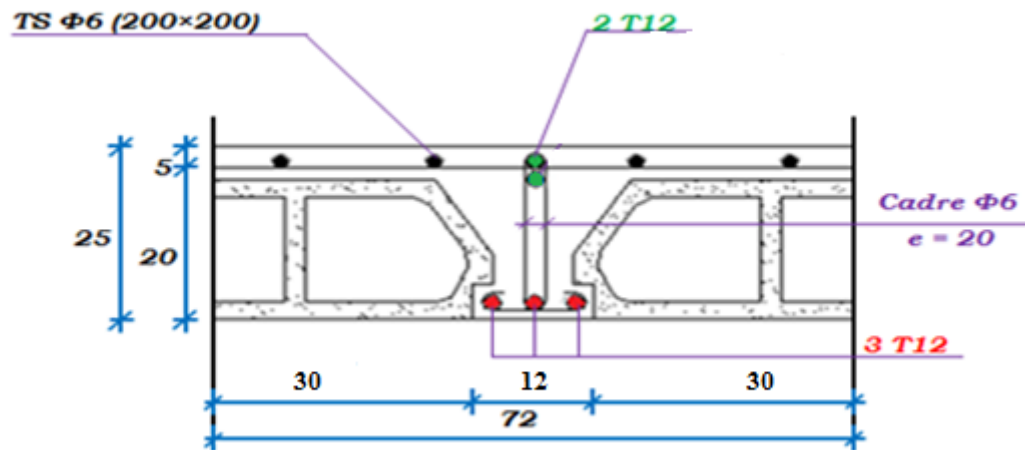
Coupe De Ferrailage Plancher Etage Courant 2 Travées
